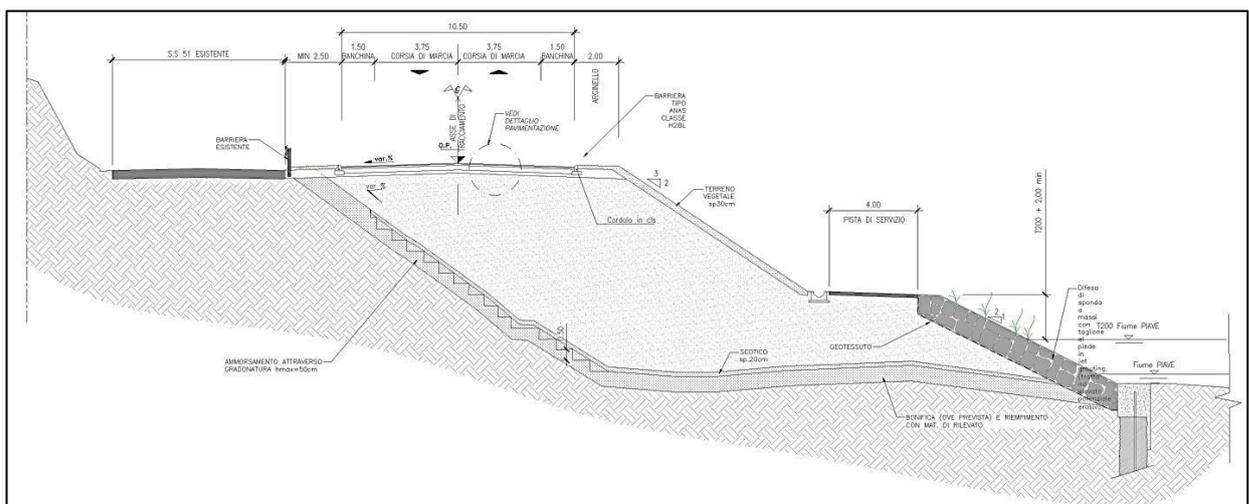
Sezione tipo C1 in affiancamento alla SS51 esistente.
